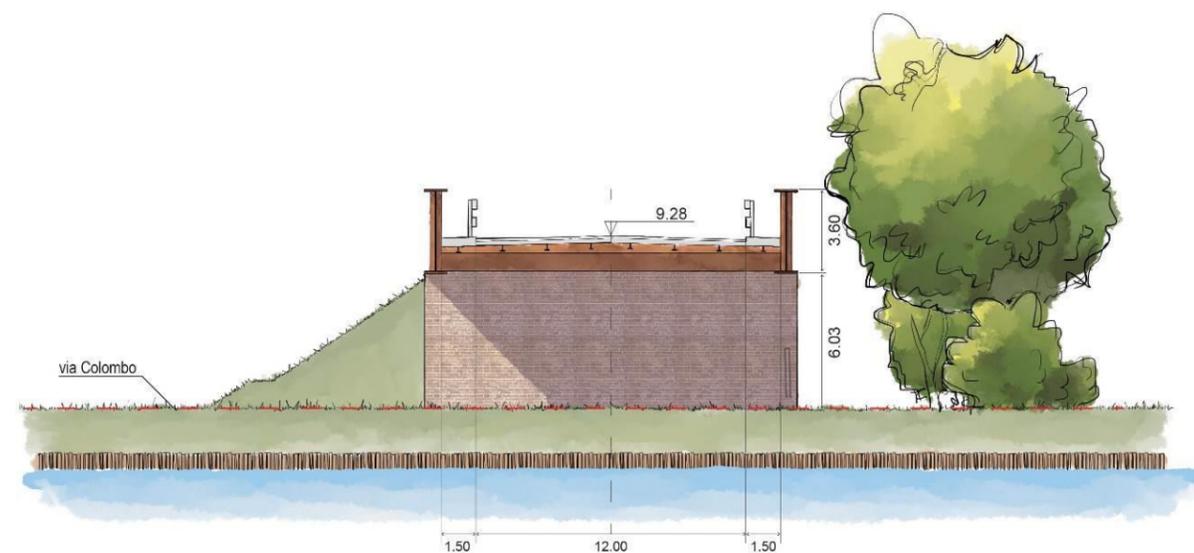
Sezione 04 all'altezza del Canale Cavetta.
